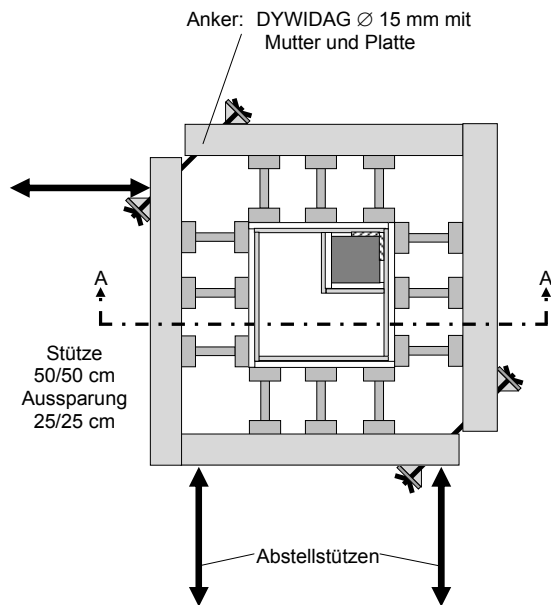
Grundriss: Konstruktion Stützenschalung
